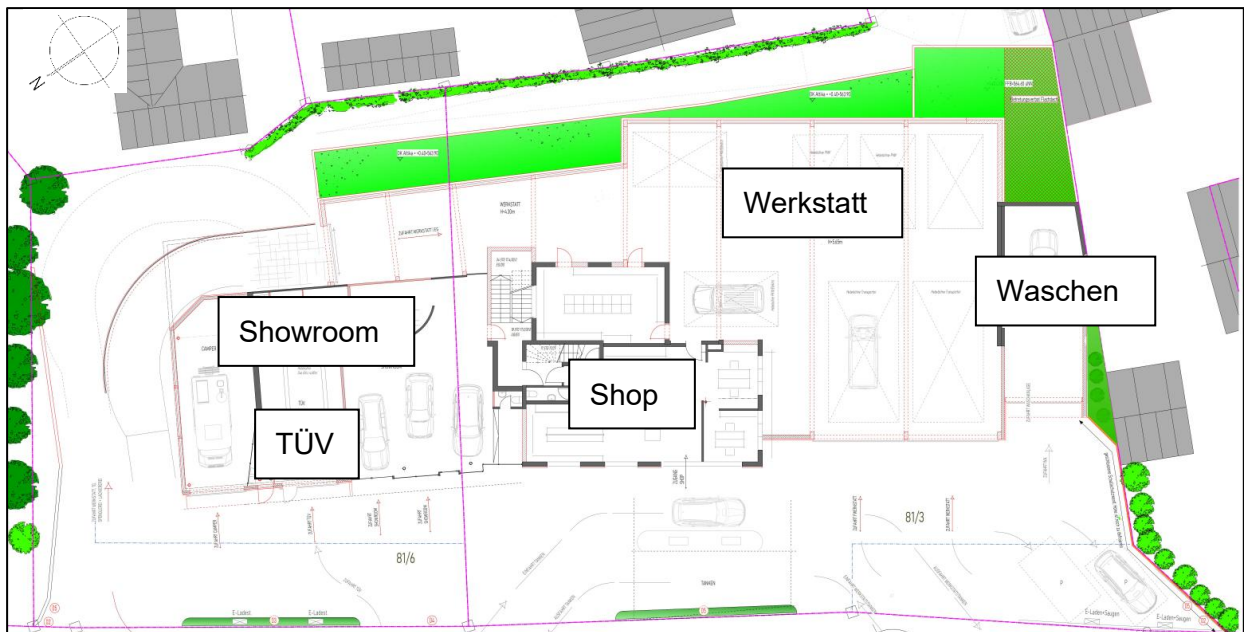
Grundrissplan Erdgeschoss Vorhaben Flur-Nummer 81/3 und 81/6 [13]
